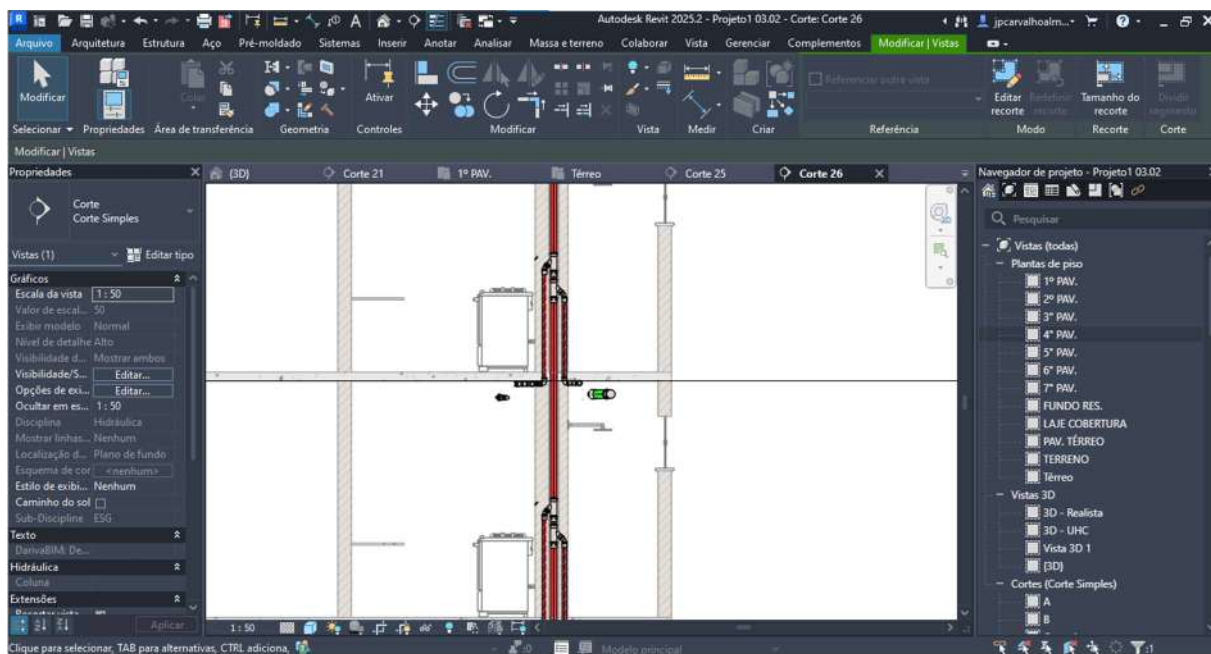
Lançamento das tubulações da cozinha e lavanderia - Corte
